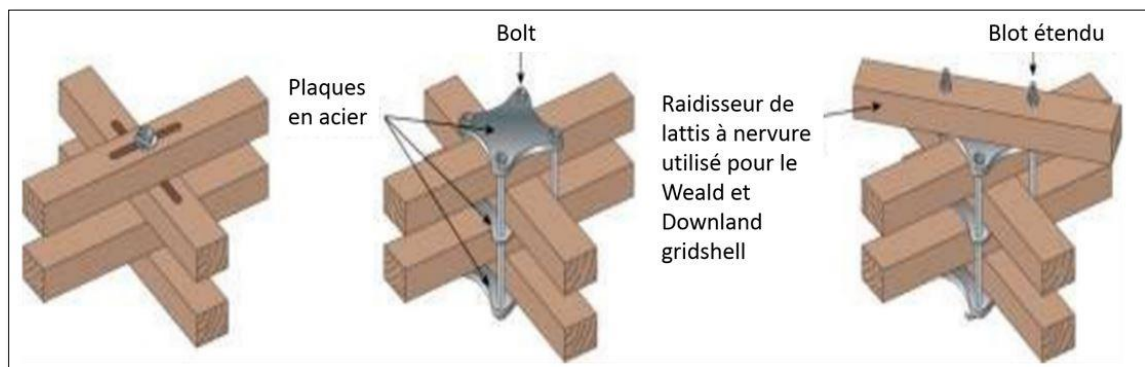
Plan et la section des bois à double épaisseur élément gridshell
